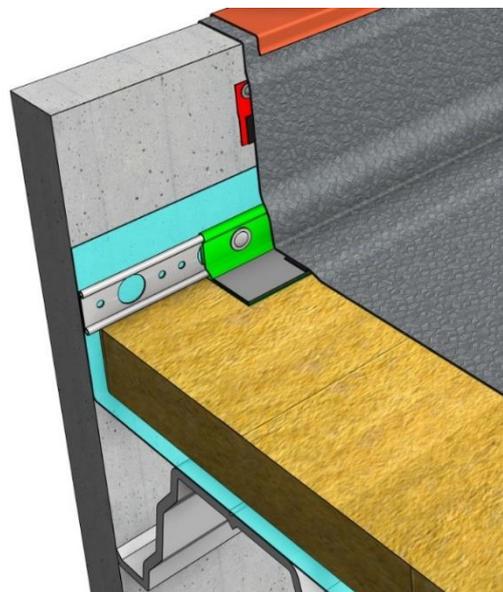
Fixation au droit du pied de relevé avec le système SECRET FIX POCKET + SECRET FIX STRIP (relevés de plus de 600 mm)
